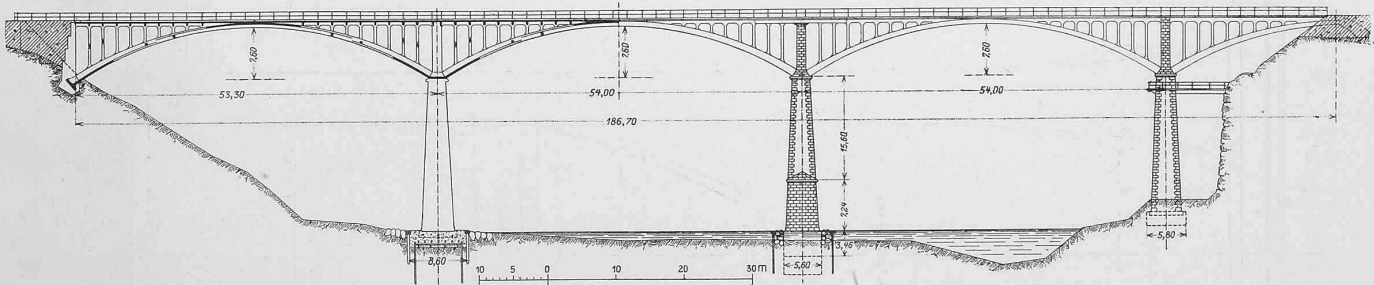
Elévation et coupe longitudinale du pont de Pymont. Echelle 1:1000.
